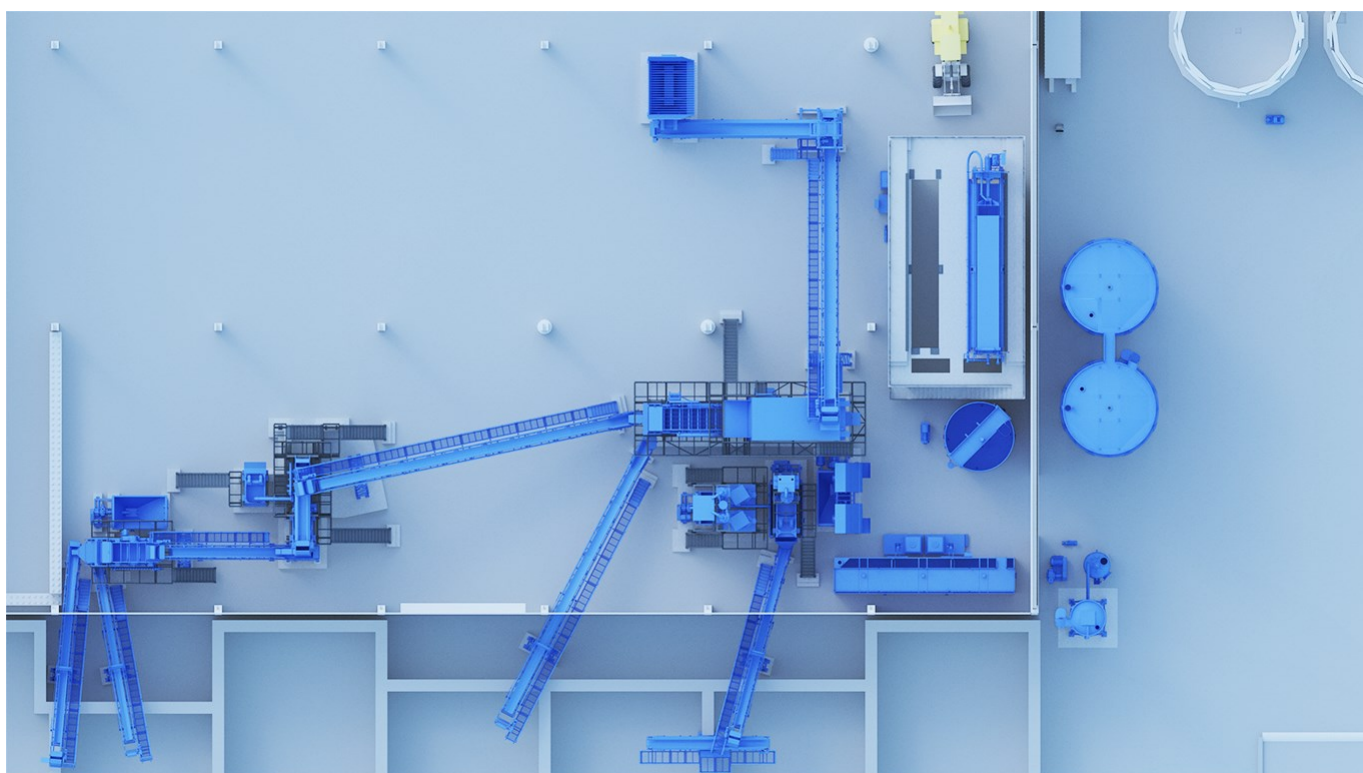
Planimetria generale 3D dell'impianto di Soil Washing installato.
